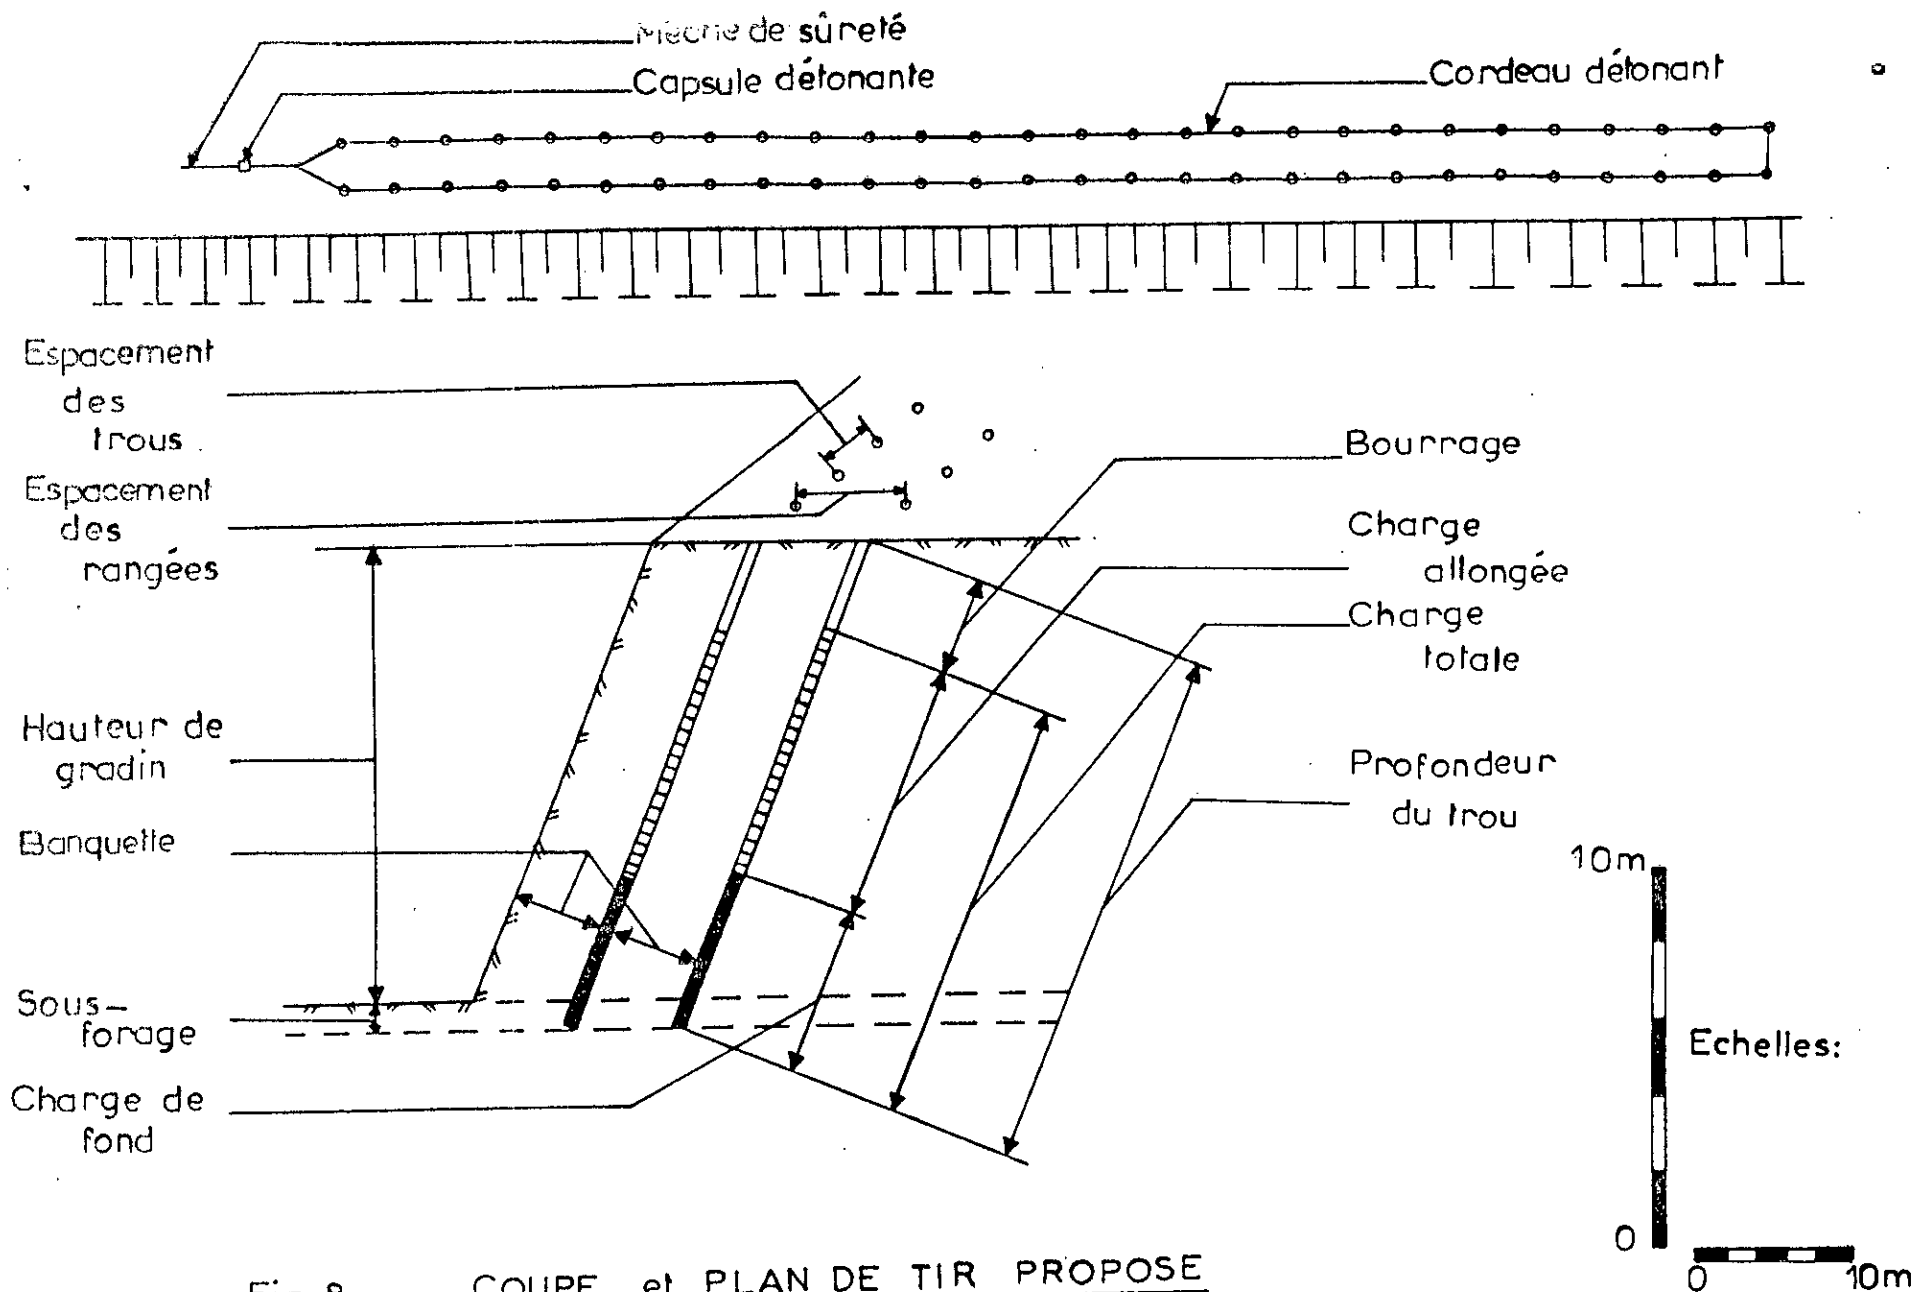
COUPE. et PLAN DE TIR PROPOSE
